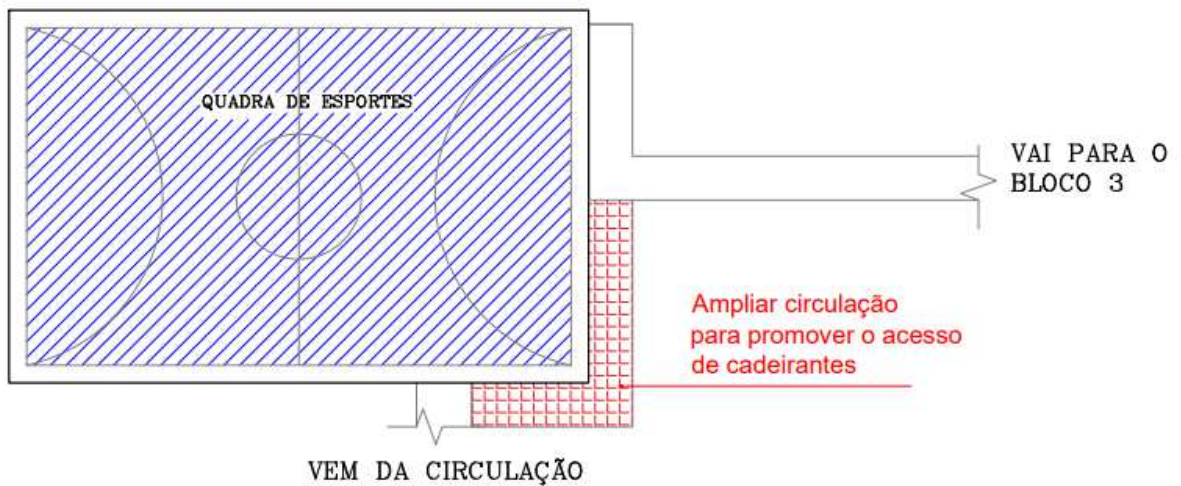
Proposta de Layout Rampa para Acesso a Quadra
